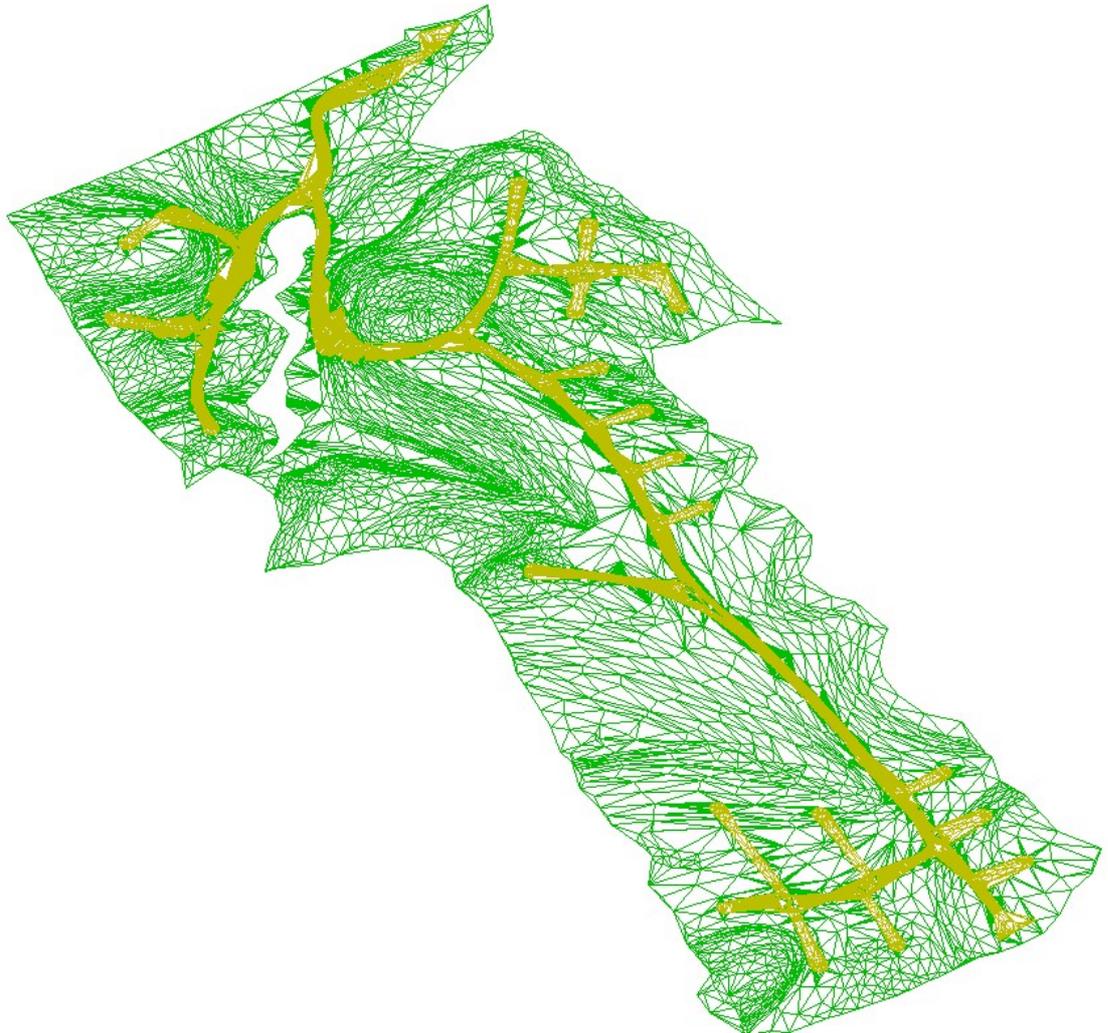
Arquivo Jmdt.dgn com a triangulação do terreno e sobreposição do arruamento.
